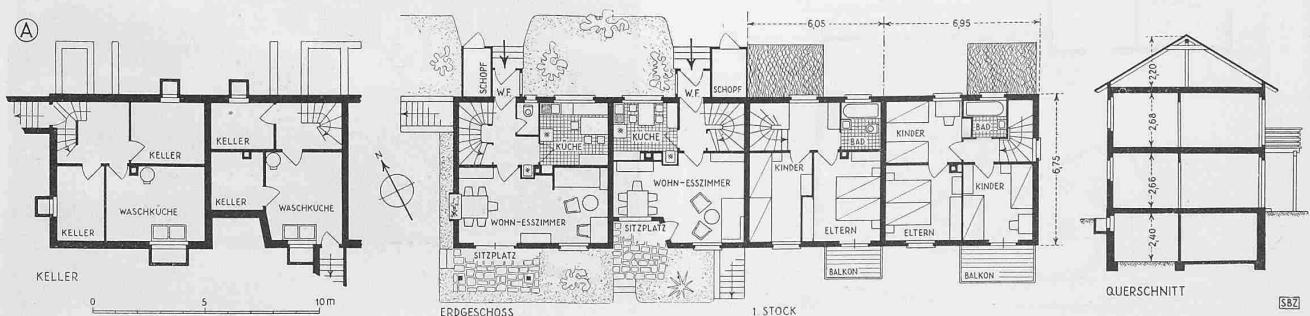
Grundrisse und Schnitt der Vierhäusergruppen Typ A
